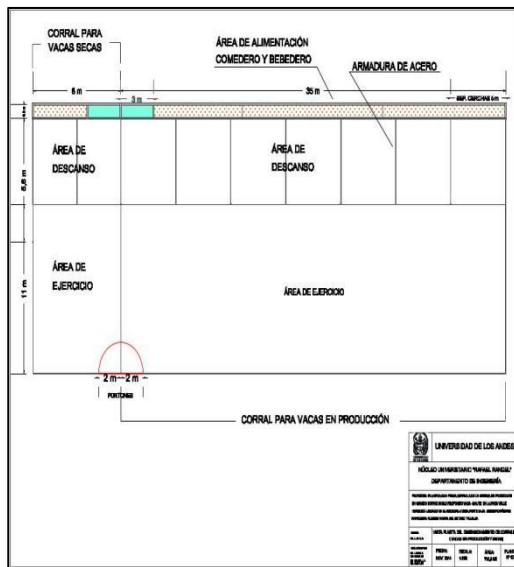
Dimensionamiento del corral de las vacas en producción y secas – vista planta
